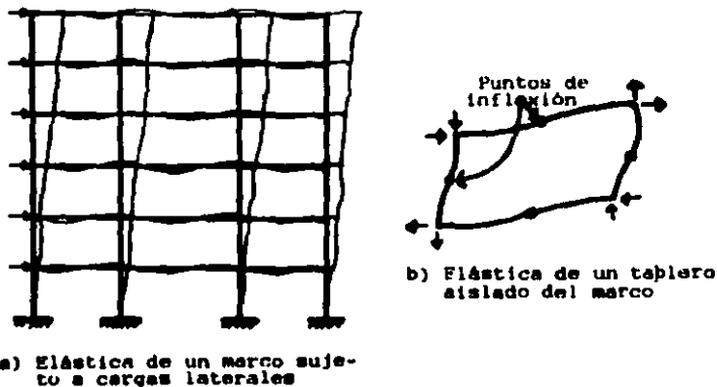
Sistema de marcos con comportamiento estructural de cortante (Cap.5,Ref.3)
